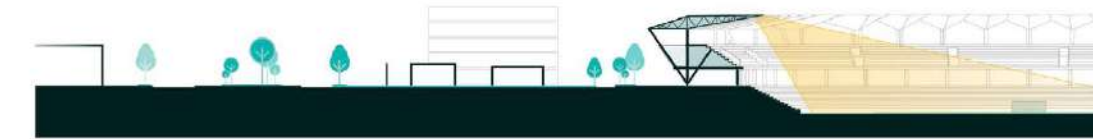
Iluminación en cubierta Fuente: Elaboración propia
